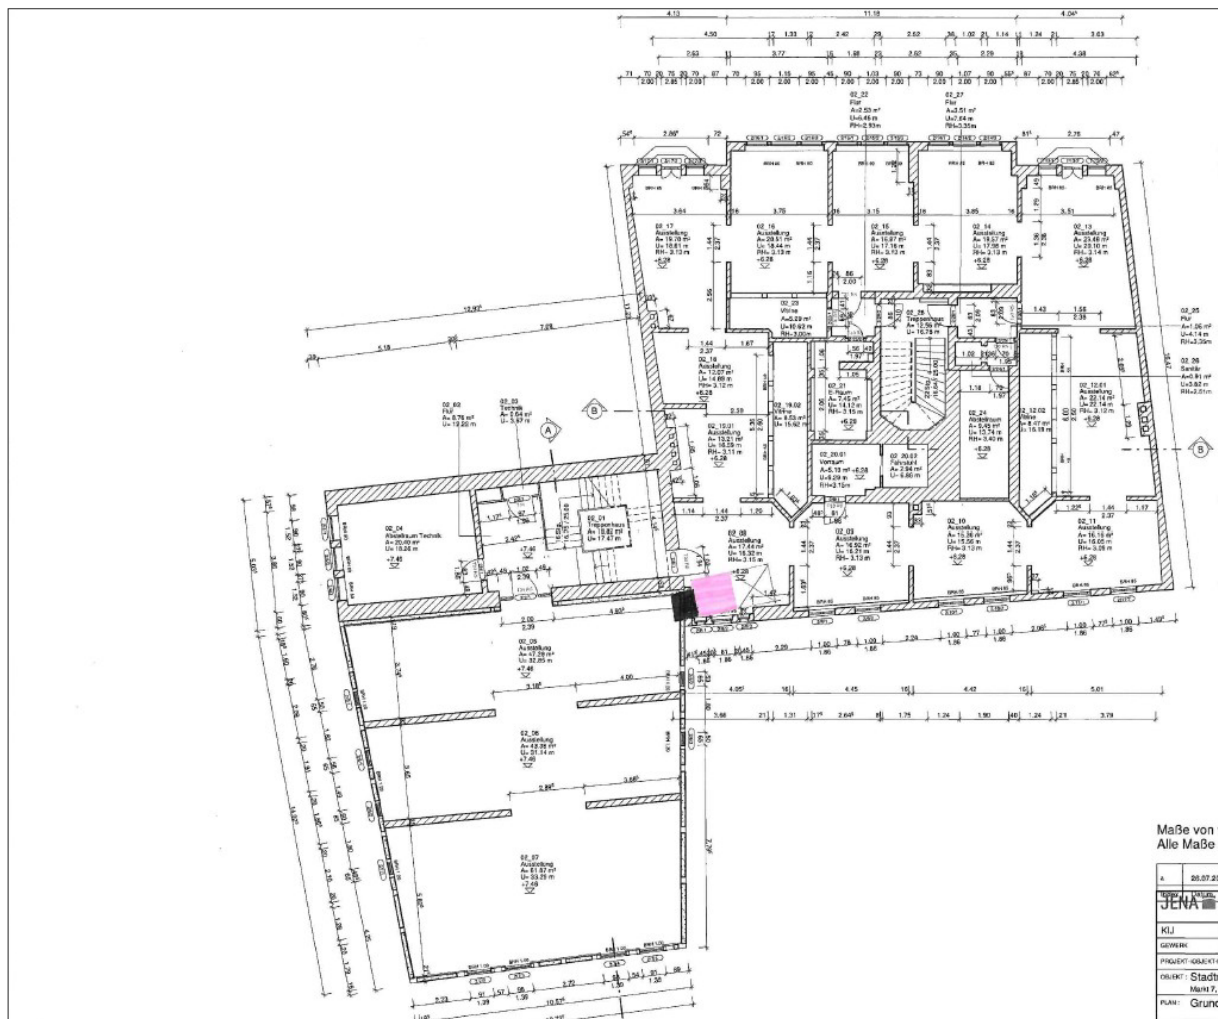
Grundriss 2. Obergeschoss Positionierung Aufzug, Variante Portal;
